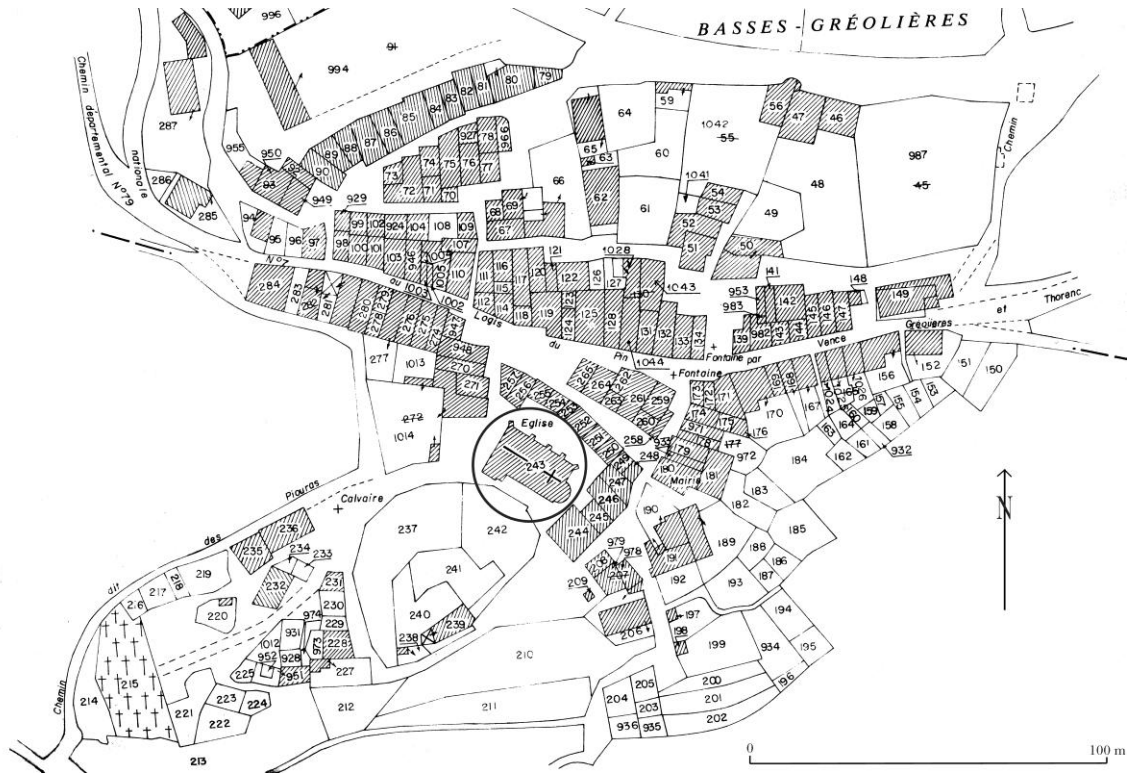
Plan de situation (parcellaire cadastral de 1985, section G).
